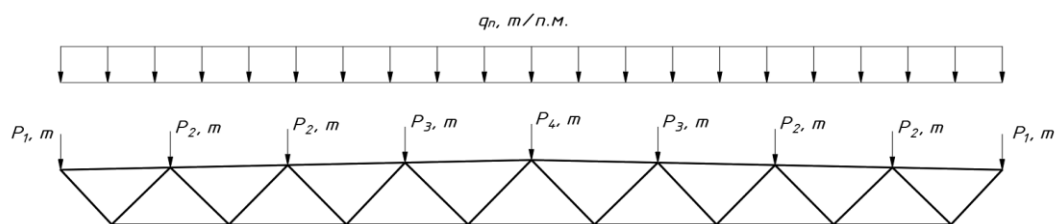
Схема приложения нагрузки от веса покрытия
